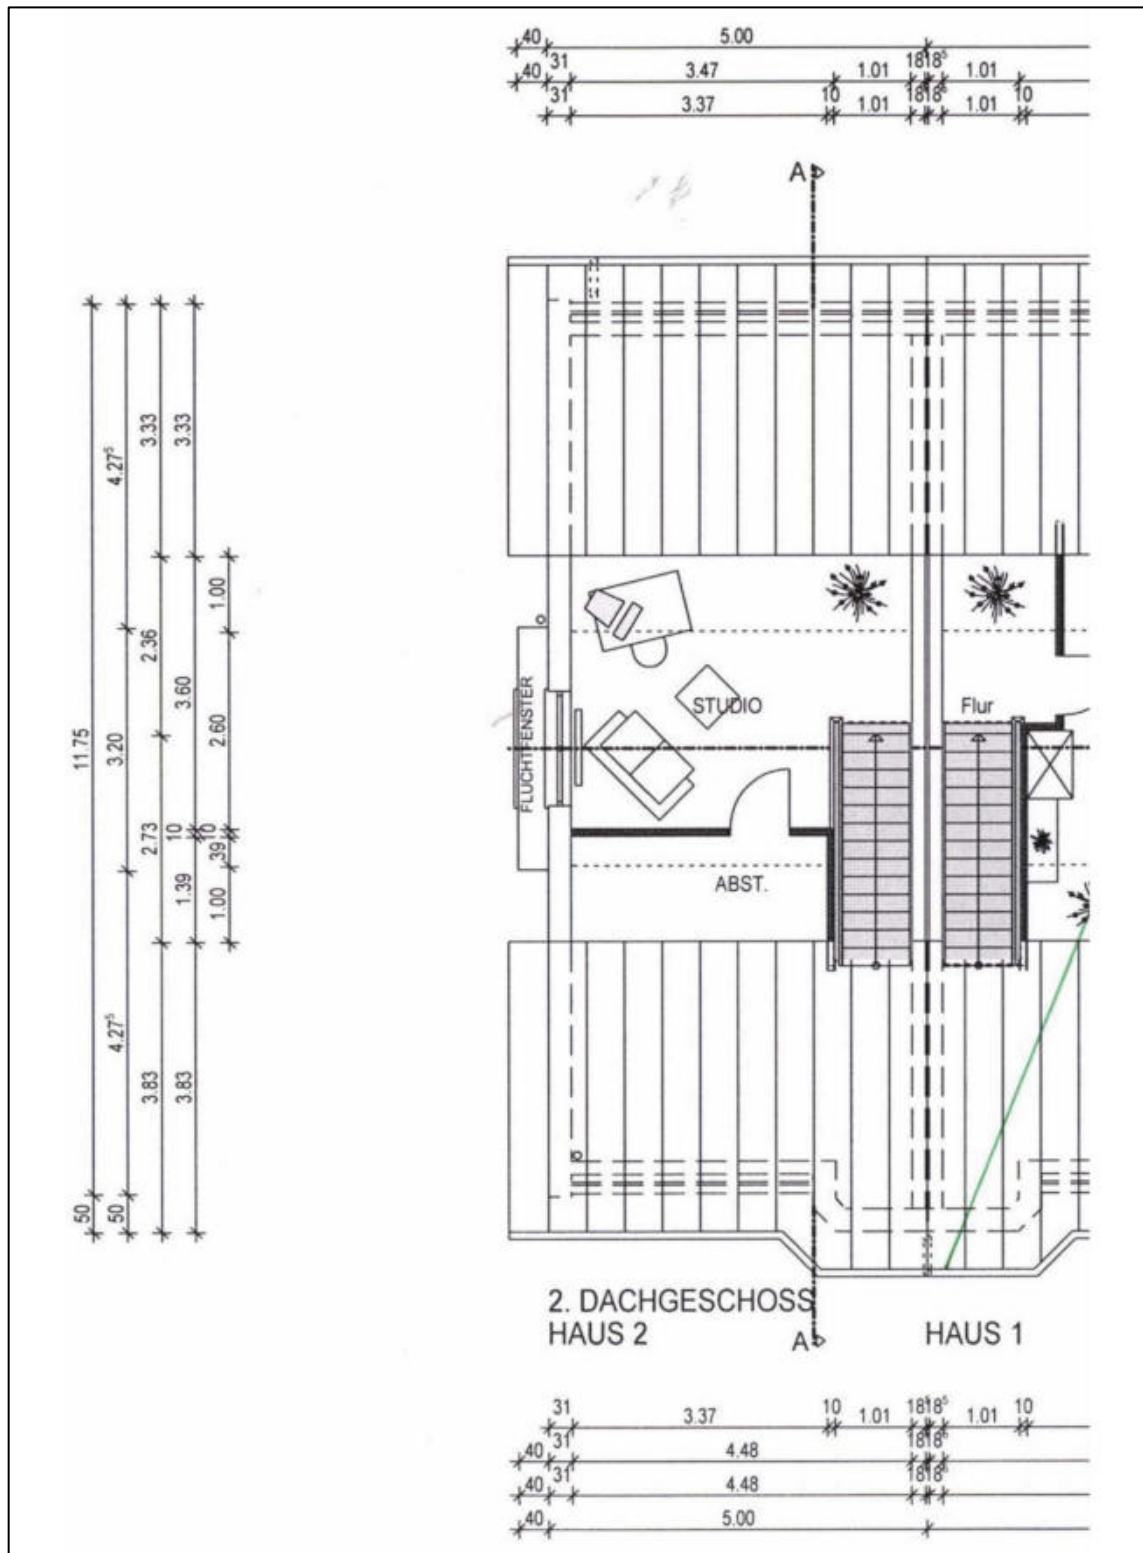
Spitzboden-Grundriss der Einfamilien Doppelhaushälfte
